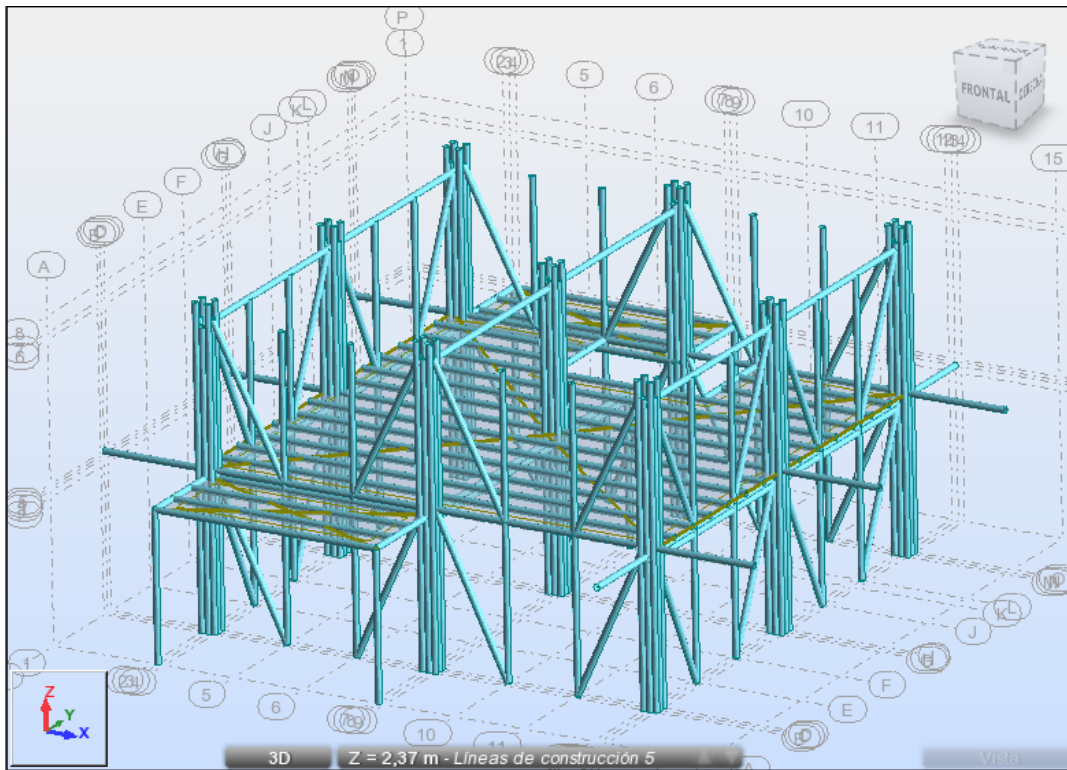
Disposición de elementos estructurales de la Vivienda de GaK.
